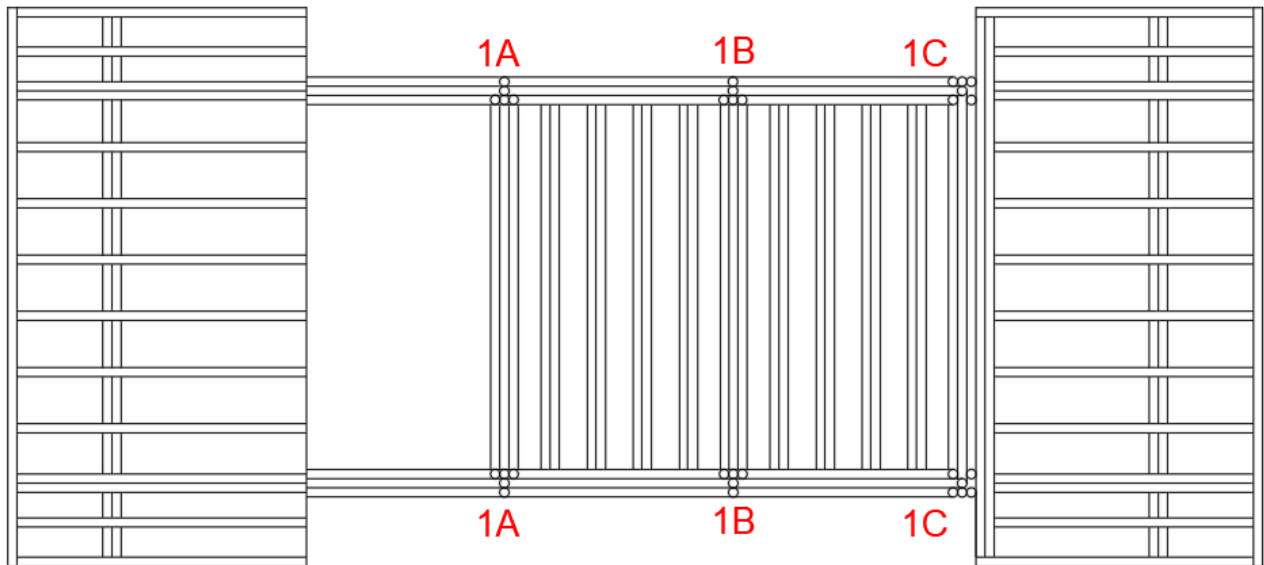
Piante del Piano Terra e del Primo Piano con la disposizione dei culmi.
